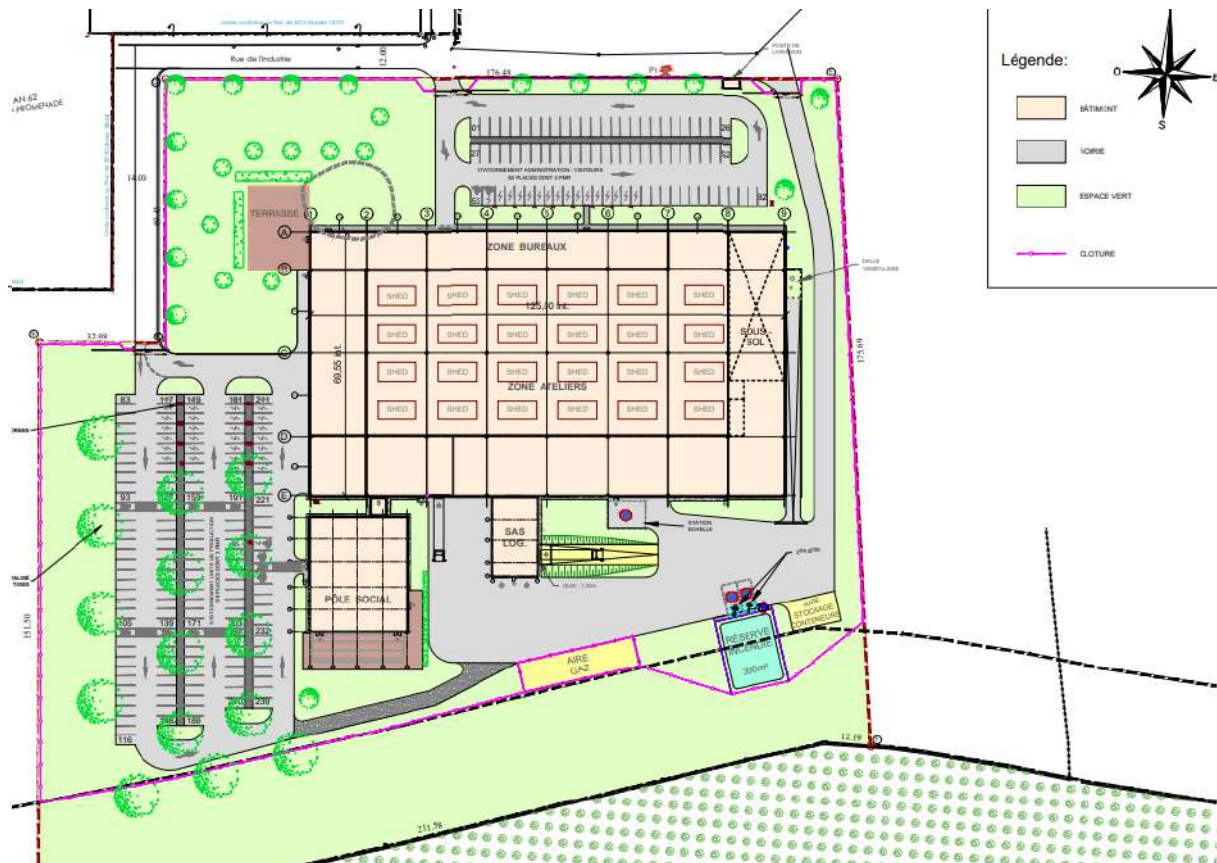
PLAN DE MASSE DE L'IMPLANTATION EXTERIEURE
